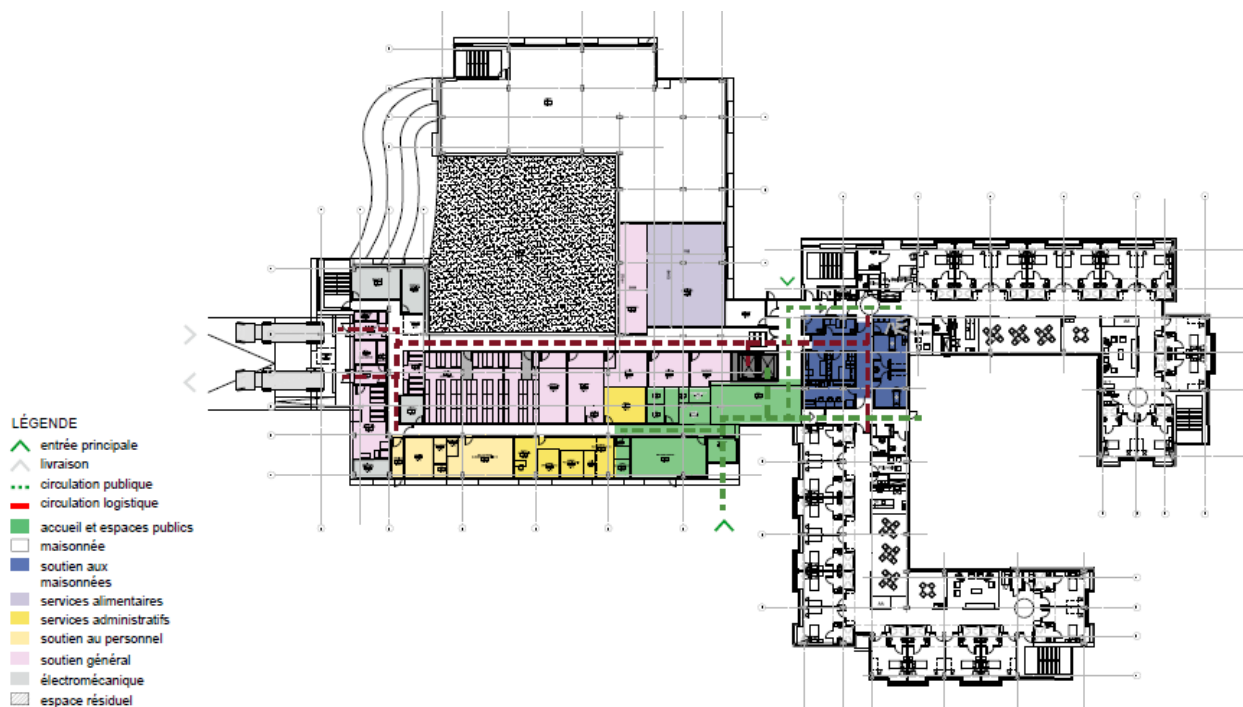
Plan type de RDC pour 96 places et plus; 1 maisonnée pour chacune des ailes
